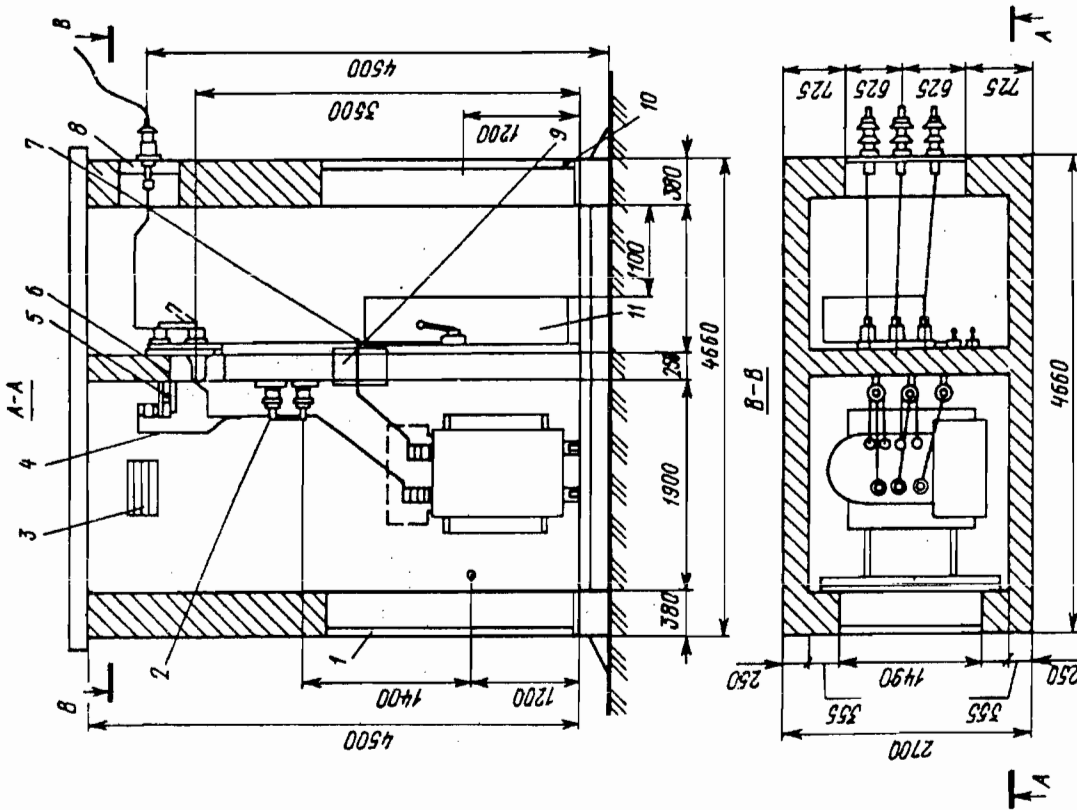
Габаритные, установочные и присоединительные размеры подстанции ЗТПС-10-11Т1В:
